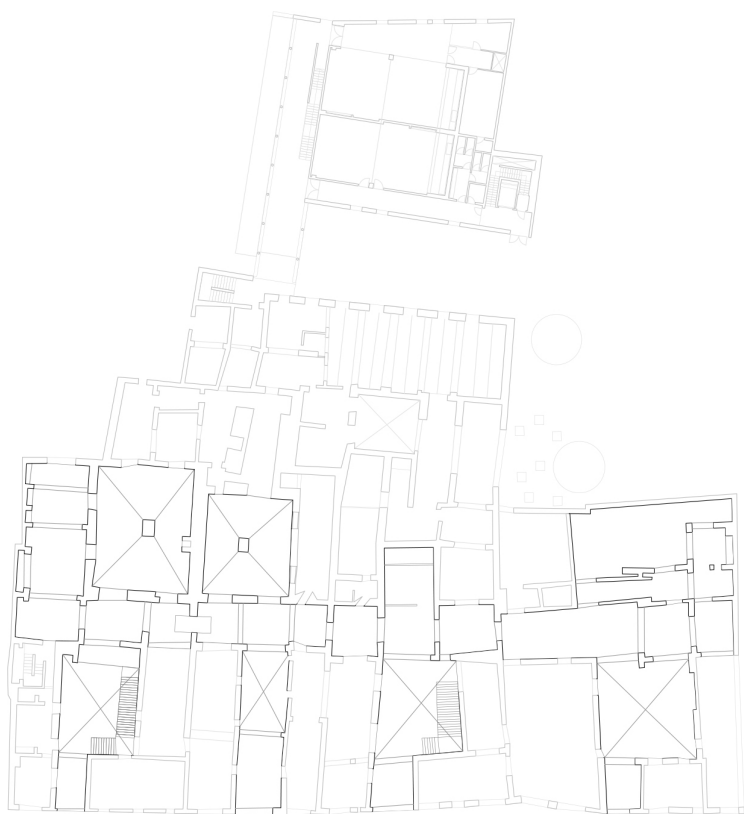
Planta baja y de vestíbulo, museo Picasso, Barcelona.
